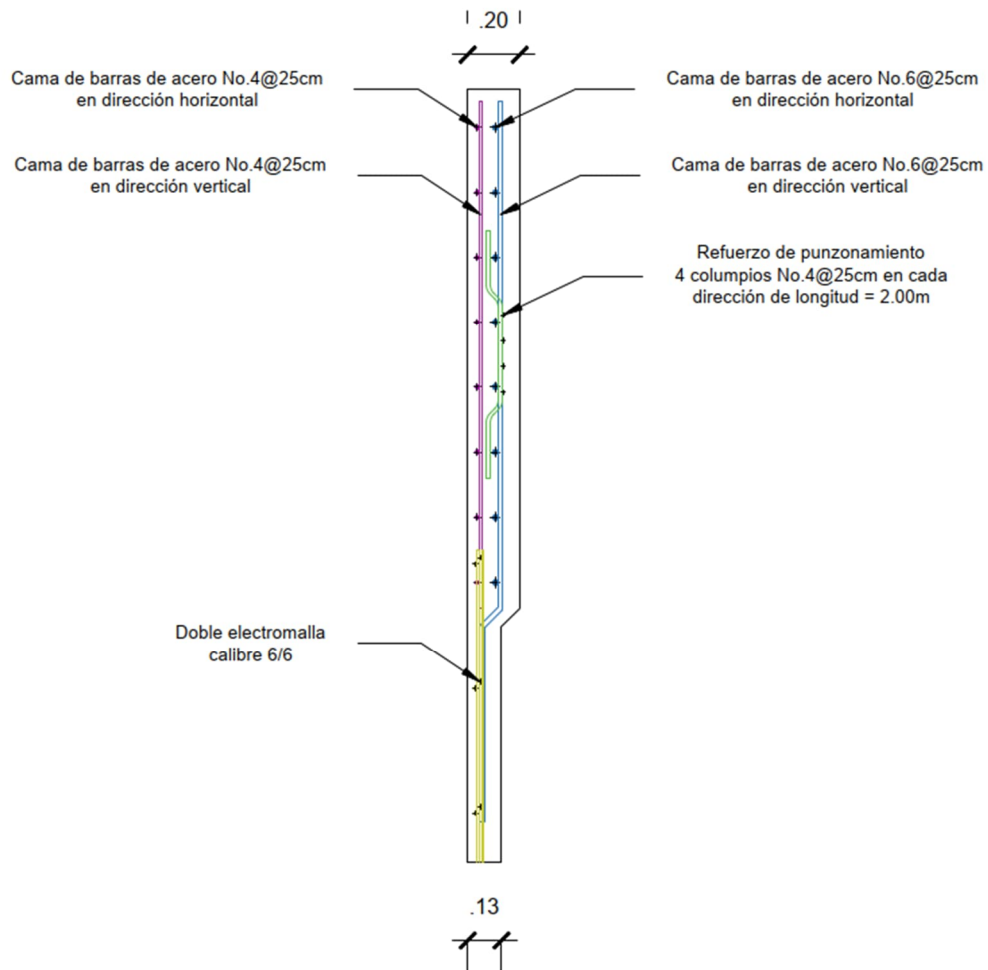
Propuesta de armado para franja de anclaje activo de 30 toneladas
